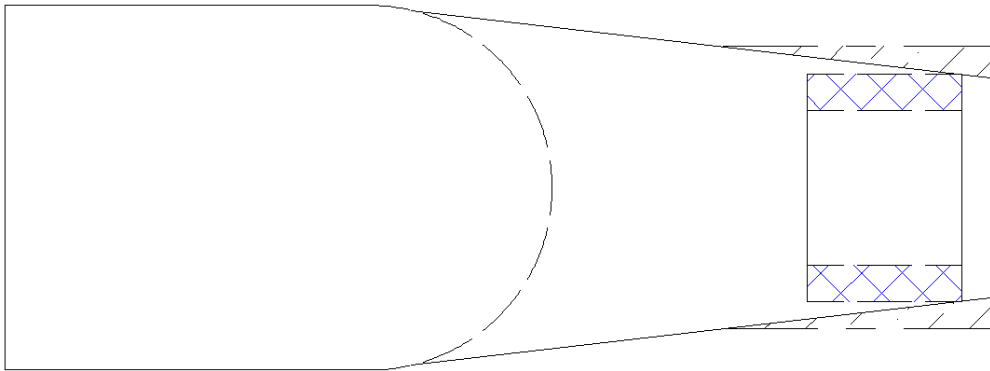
Alternativa de refuerzo 2. Vista en planta.
